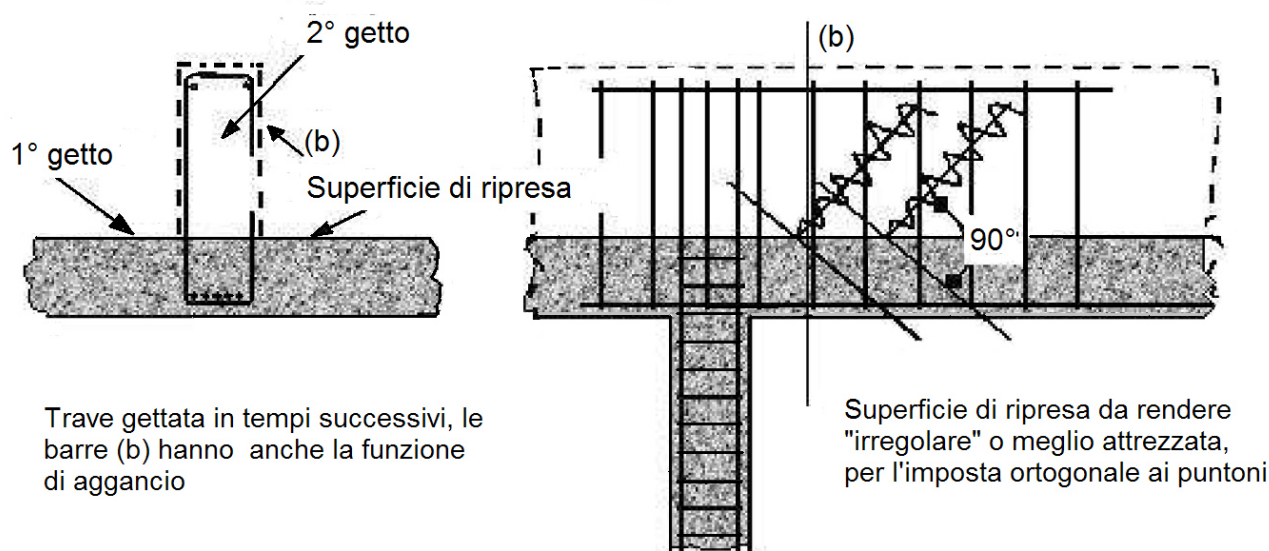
Modalità di ripresa del getto su travi di spessore elevato
